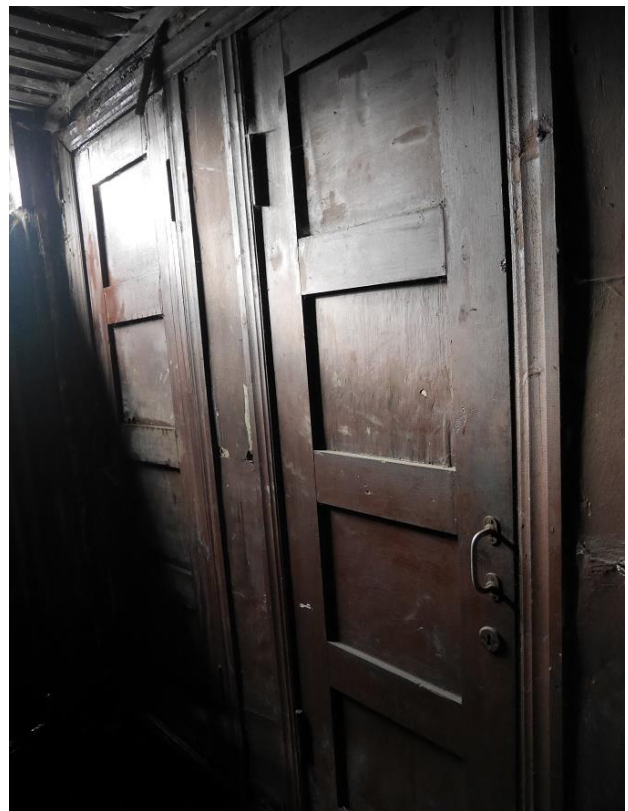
Siseuksed SU-12, SU-13. Aprill 2017
